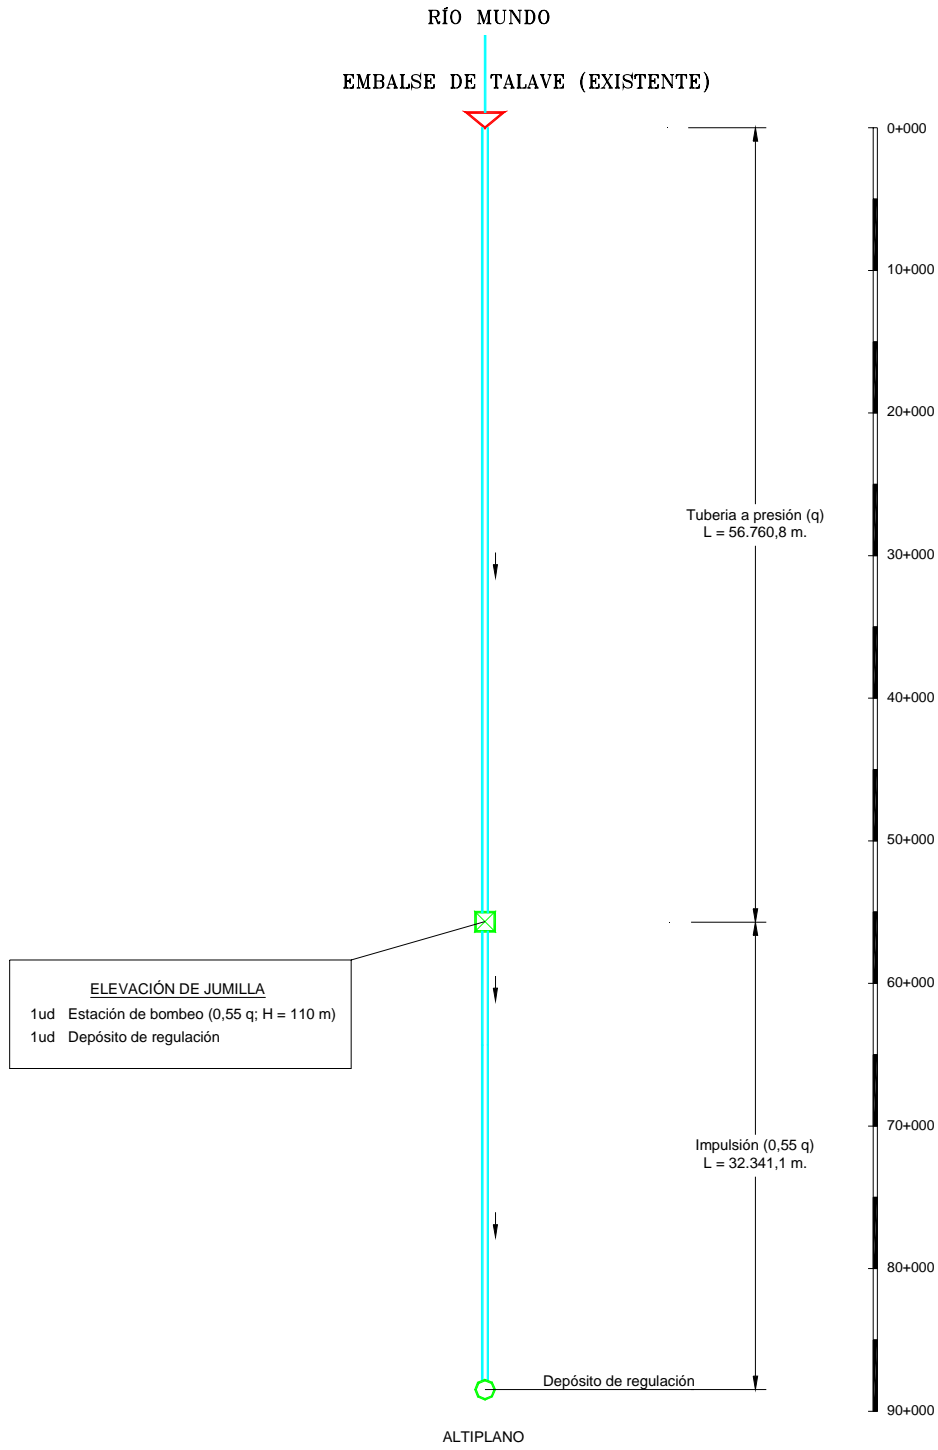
Conducción Talave-Altiplano. Esquema en planta
